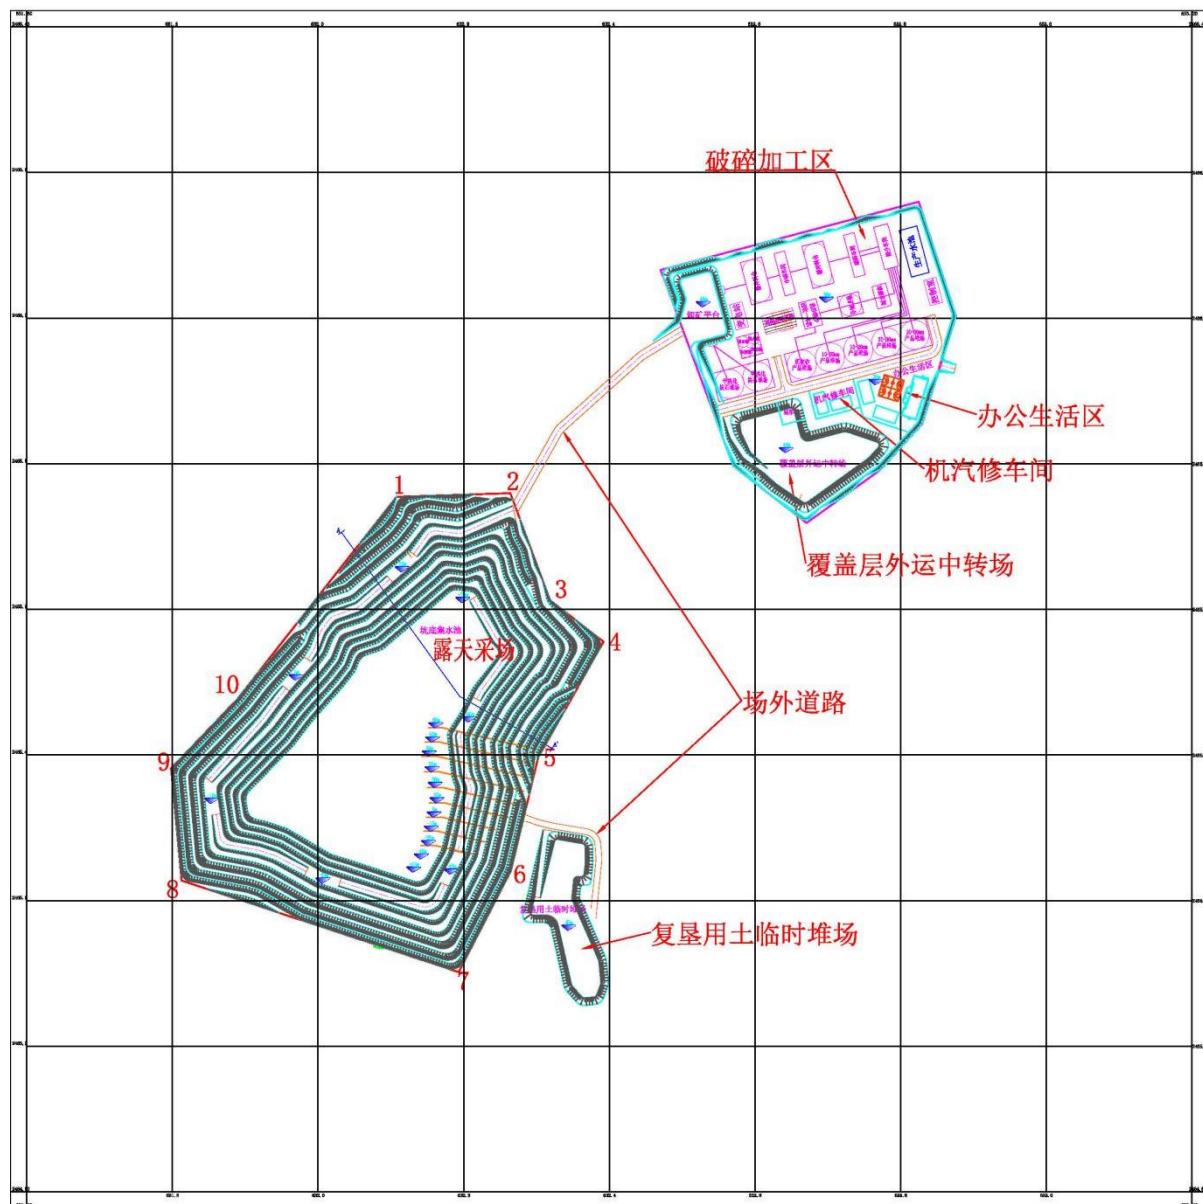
终了总平面布置图 (来源于: 《开采方案》)
